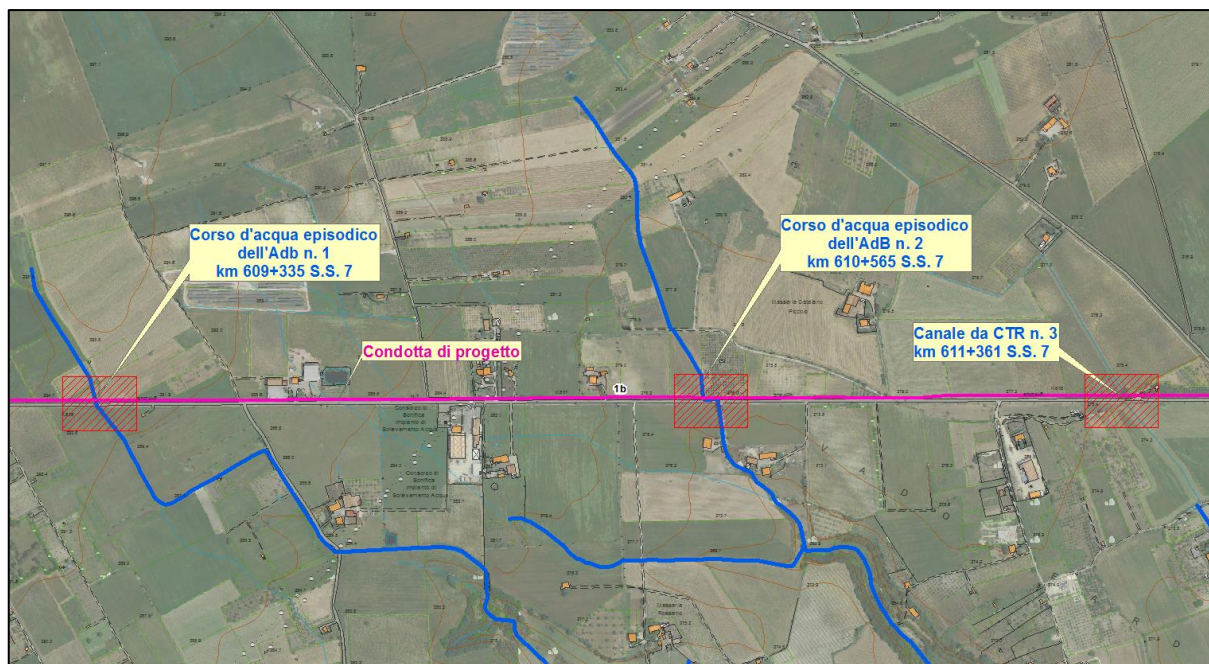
Stralcio planimetrico con individuazione delle interferenze dell'intervento– ID1b con i Corsi d'acqua episodici n.1 e n.2 e con il Canale da CTR n. 3
